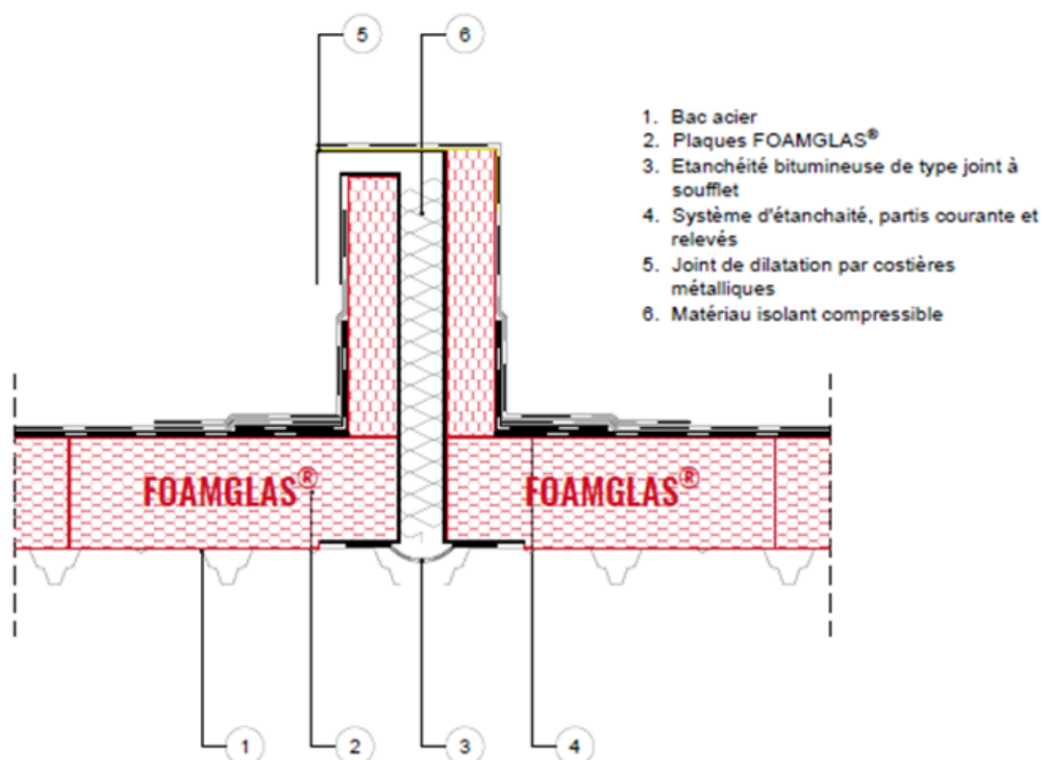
Coupe sur joint de dilatation avec costière sur TAN en local TFH
